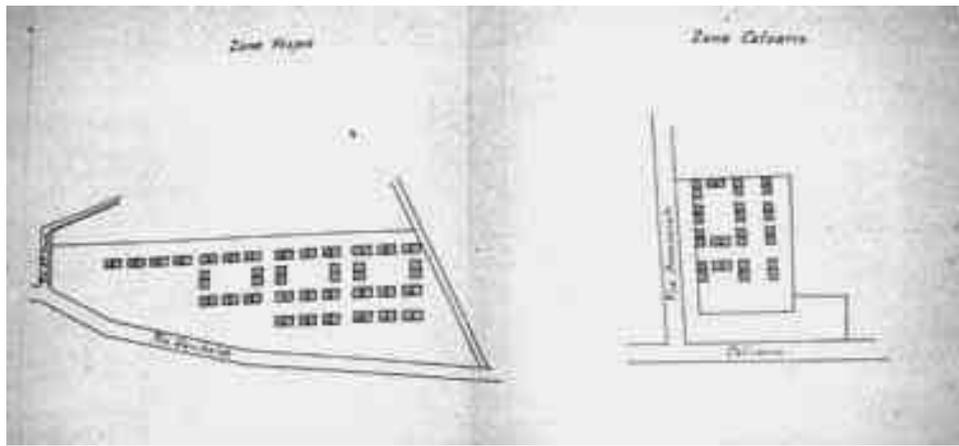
a 14. Planimetria dei baraccamenti (Archivio di Stato di Reggio Calabria, Inv. 25, F. 350).
